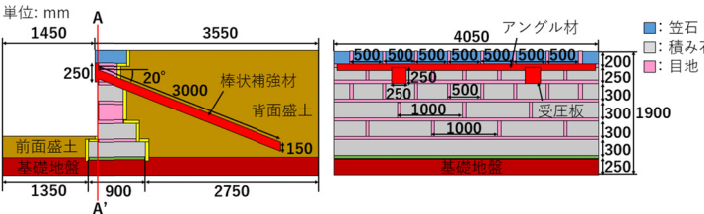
補強ケース解析モデル (左)側面図、(右)正面図(A-A'断面)
